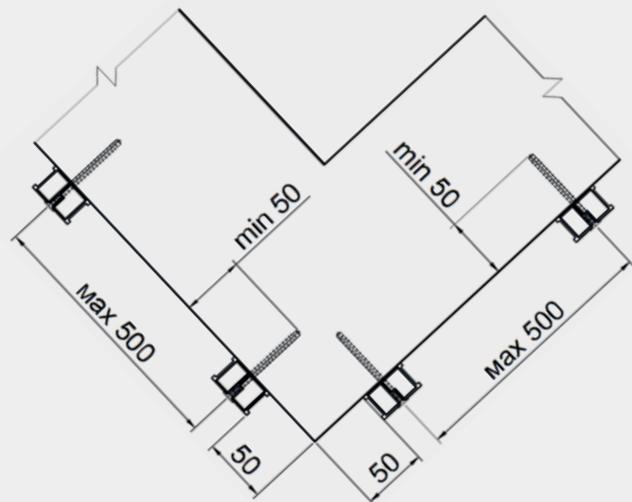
Монтаж несущего профиля для крепления фасада в горизонтальном положении
